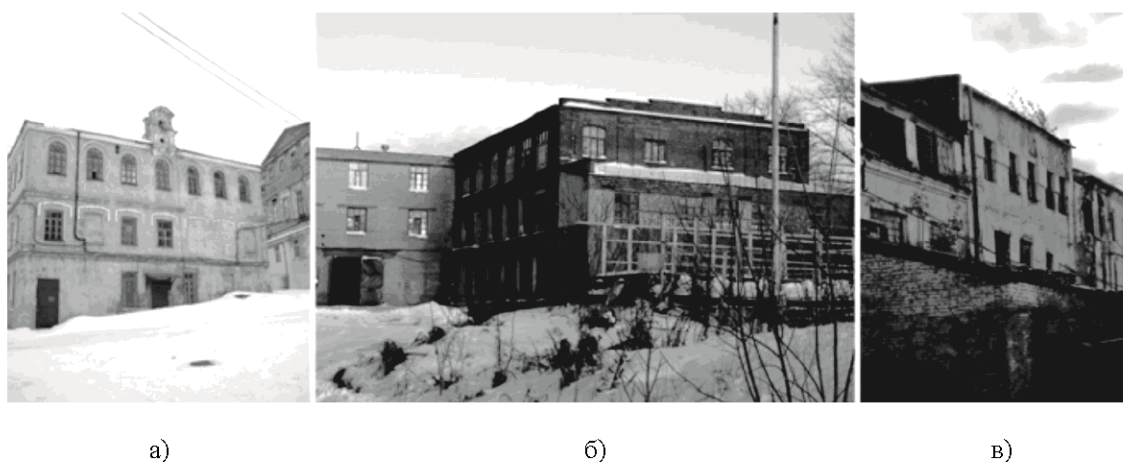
Современная фотофиксация: а) Ткацкий корпус (ОКН); б) Палетный корпус; в) Дубильный корпус
